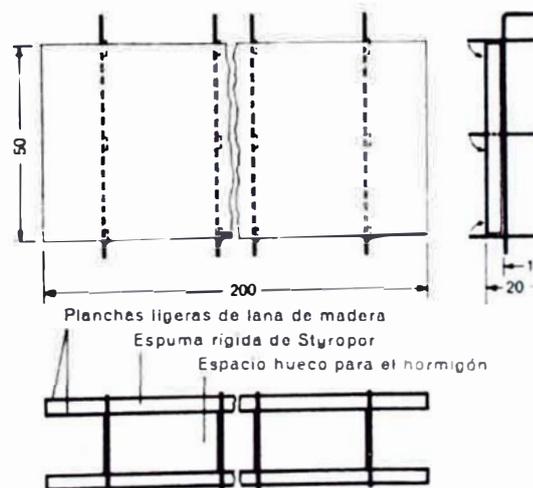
Esquema de un panel sándwich para encofrado perdido.
